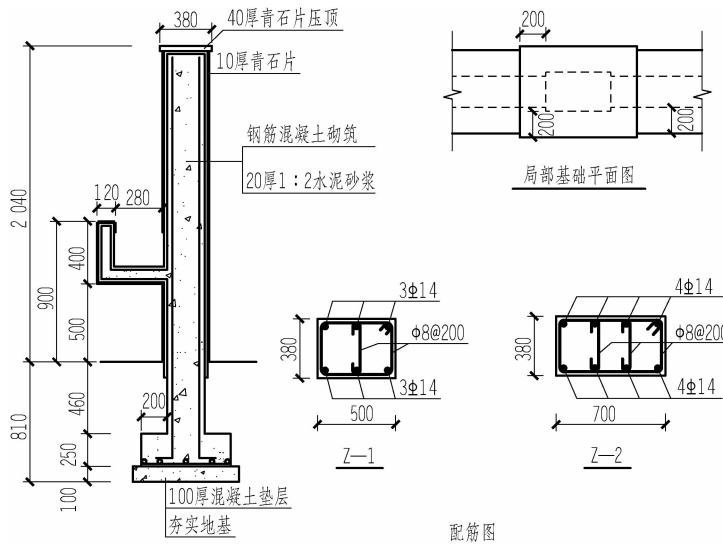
景墙剖面图、局部基础平面图及配筋图
